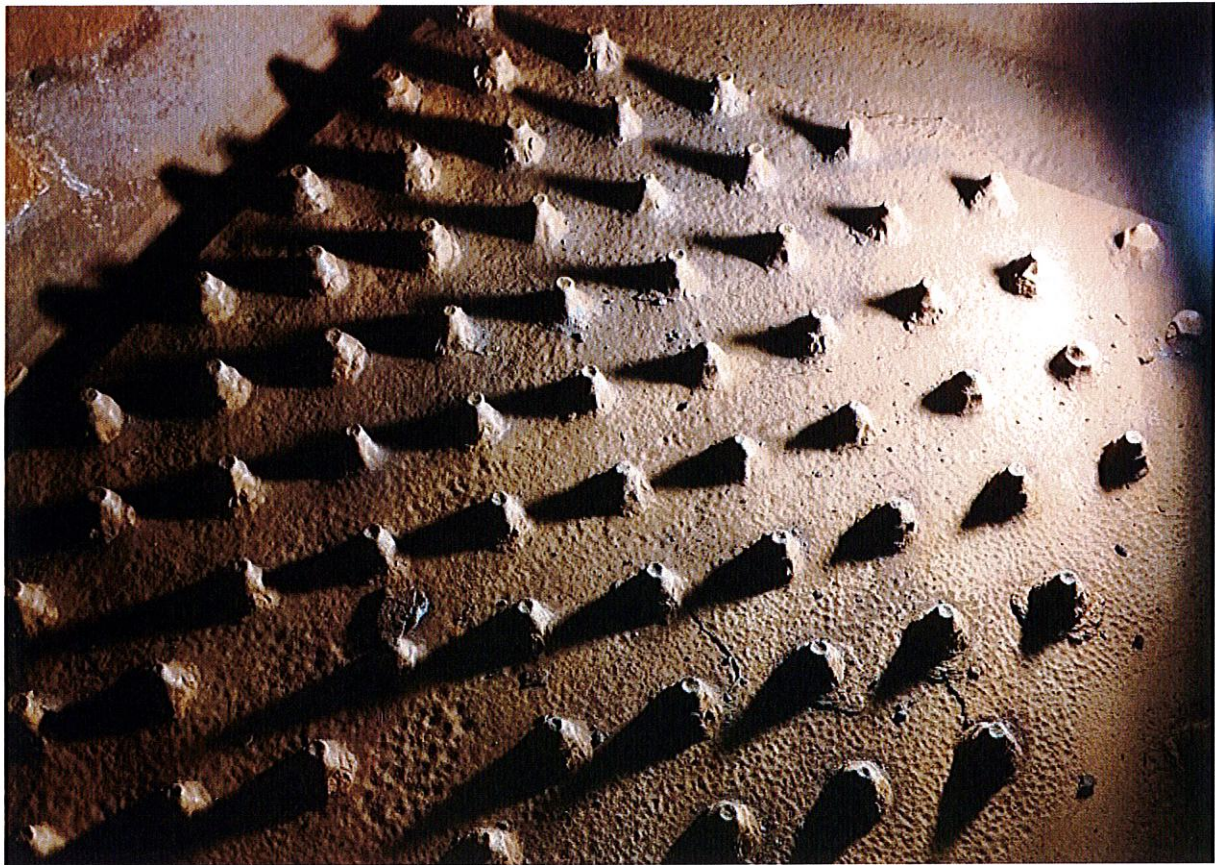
esempio di riduzione della sezione dei bulloni su giunti di fondo. Tale situazione è ricorrente, in maniera simile, su tutti i giunti di fondo delle campate dalla 2 alla 7.
